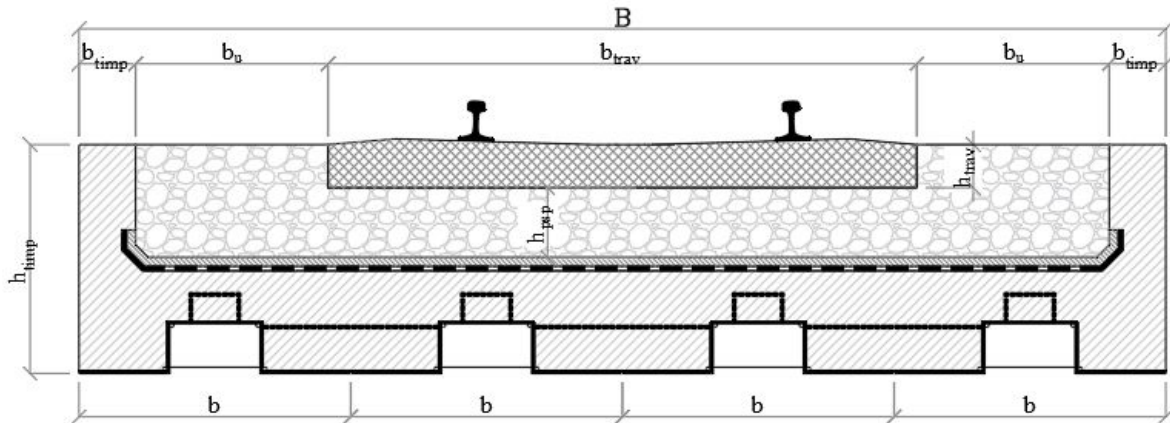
1 – Secțiune transversală dală cutată cu secțiune mixtă oțel-beton
